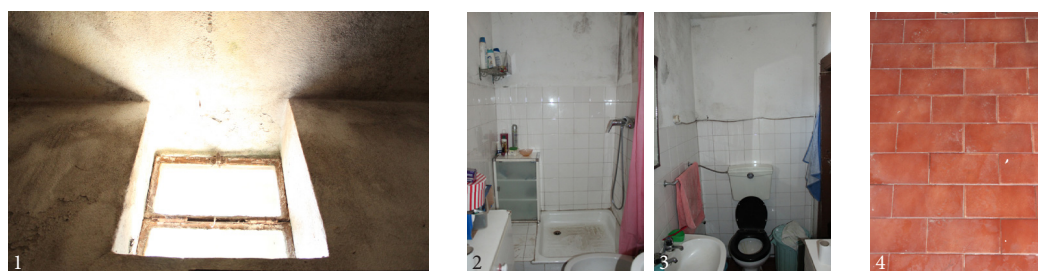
Fotos da Casa de Banho Privativa. 1) Janela e teto; 2) Vista Casa de Banho; 3) Vista Casa de Banho; 4) Pavimento
